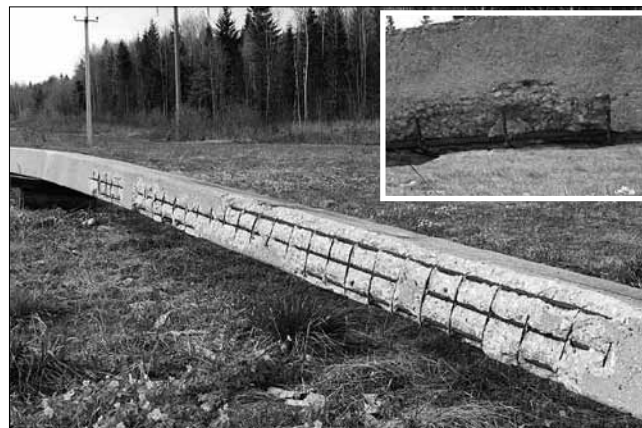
Морозное разрушение защитного слоя бетона в железобетонной опоре линий электропередачи (в верхнем углу фрагмент обнаженного арматурного каркаса)
